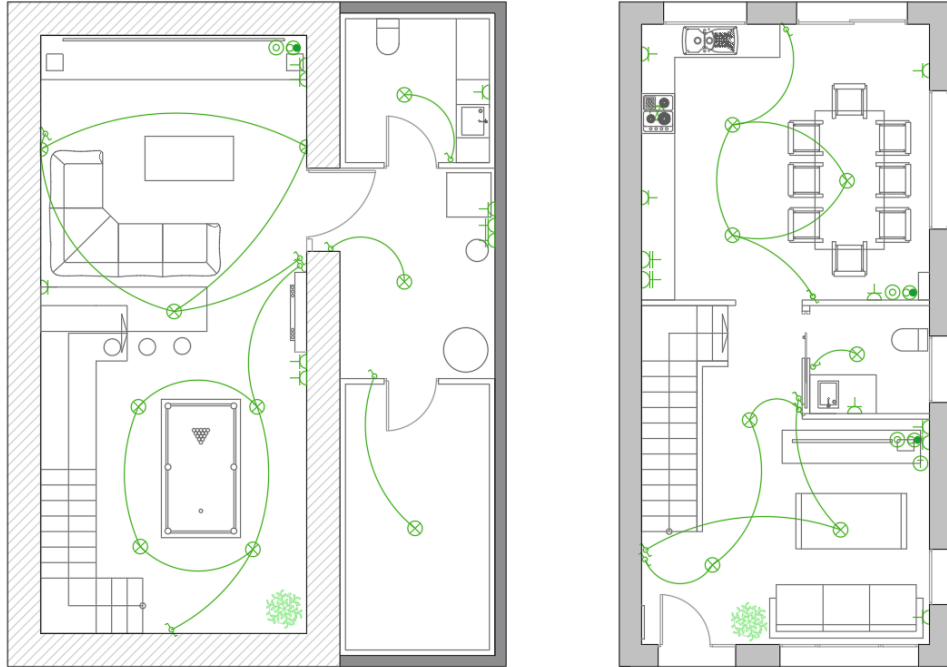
Esquema instalación eléctrica planta sótano y planta baja. 2019. Fuente propia.
